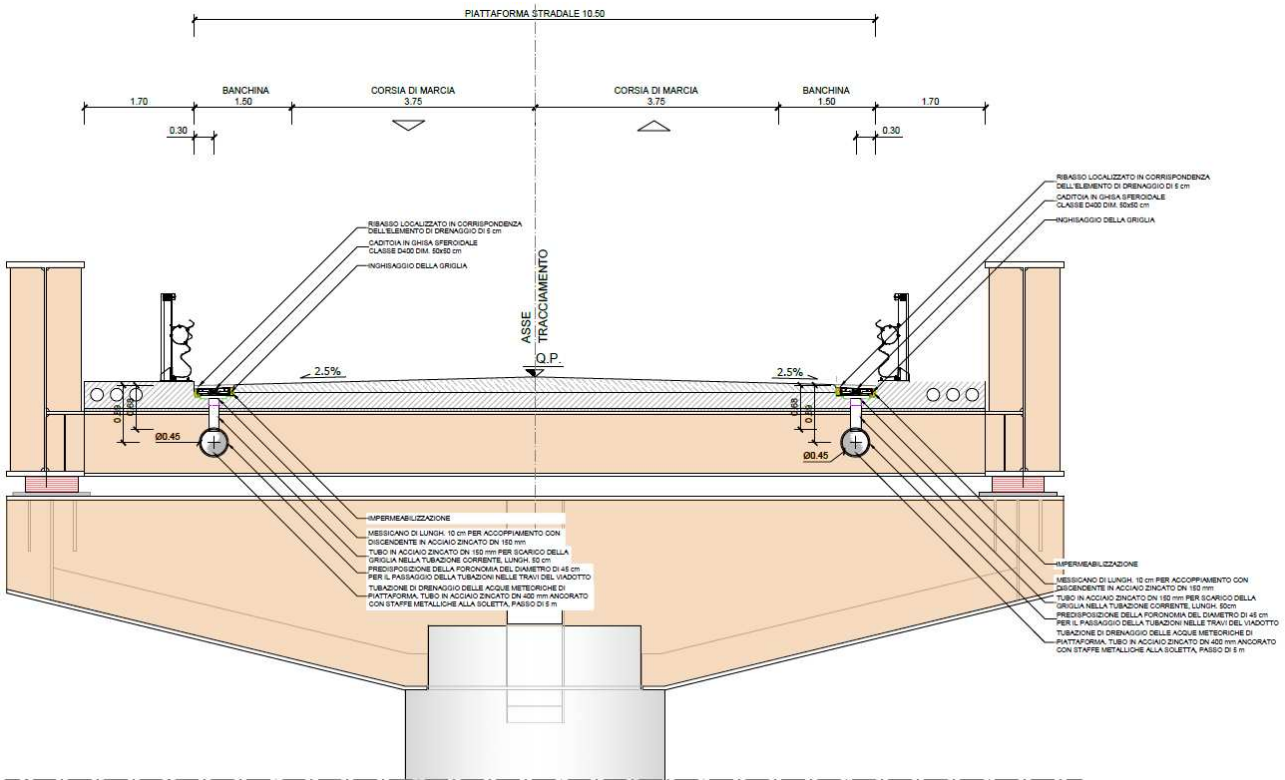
Sezione tipo del Viadotto Sieve I
